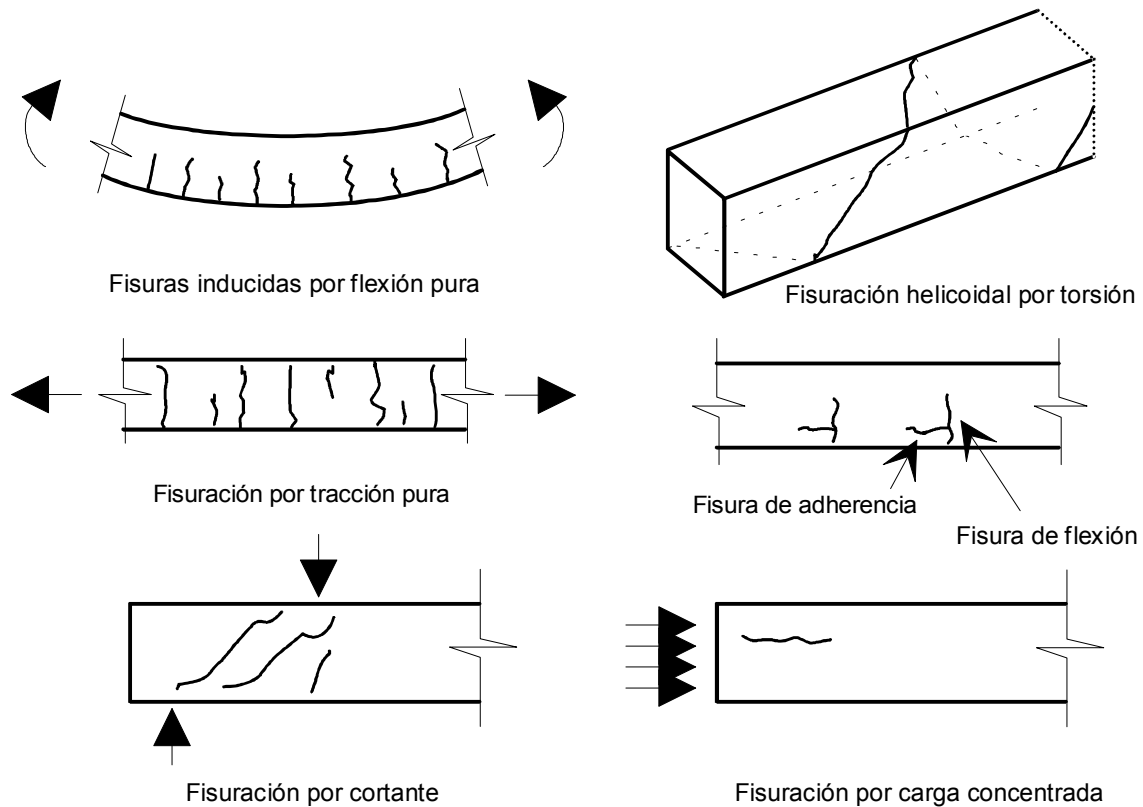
Fisuras generadas por cargas directas.
